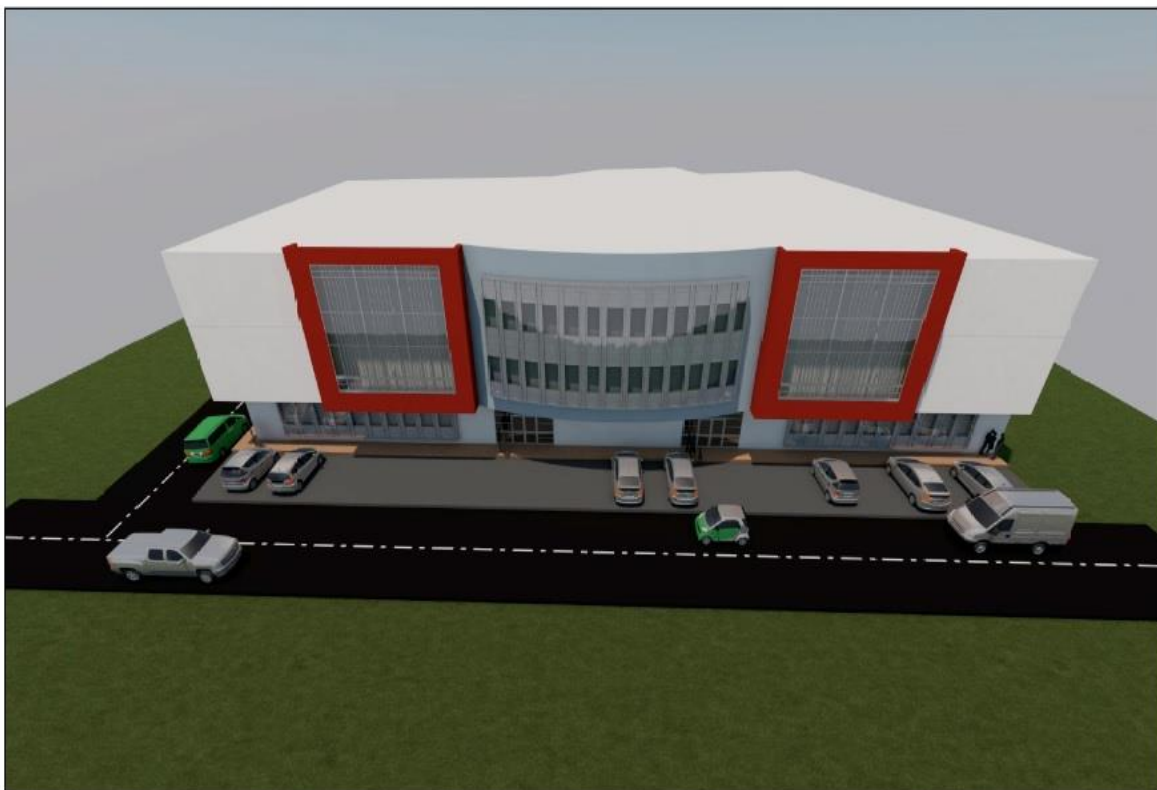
Perspectiva arquitectónica del local comercial. Fuente: Planos del proyecto
